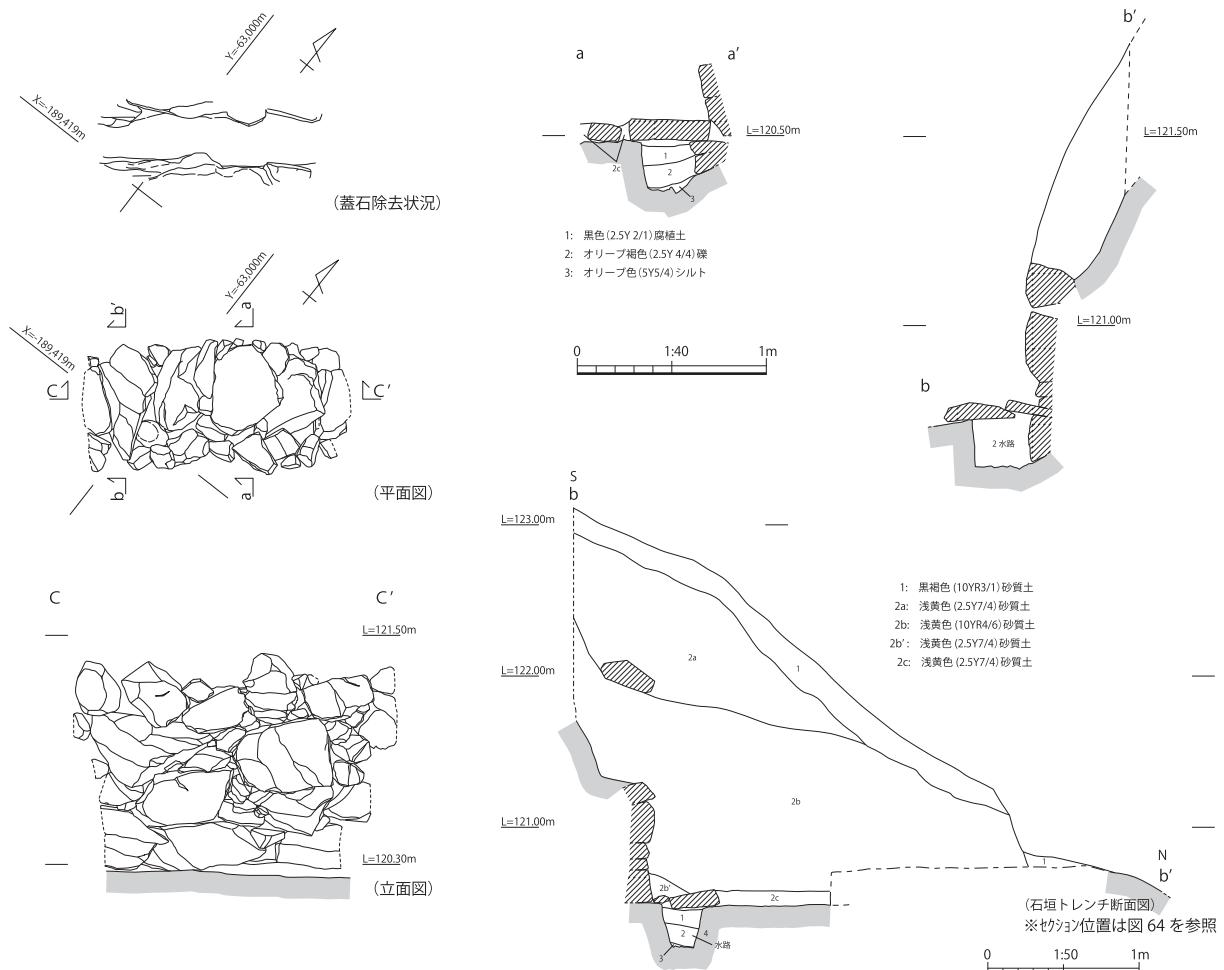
3石垣 平面図・断面図及び石垣トレーンチ断面図
